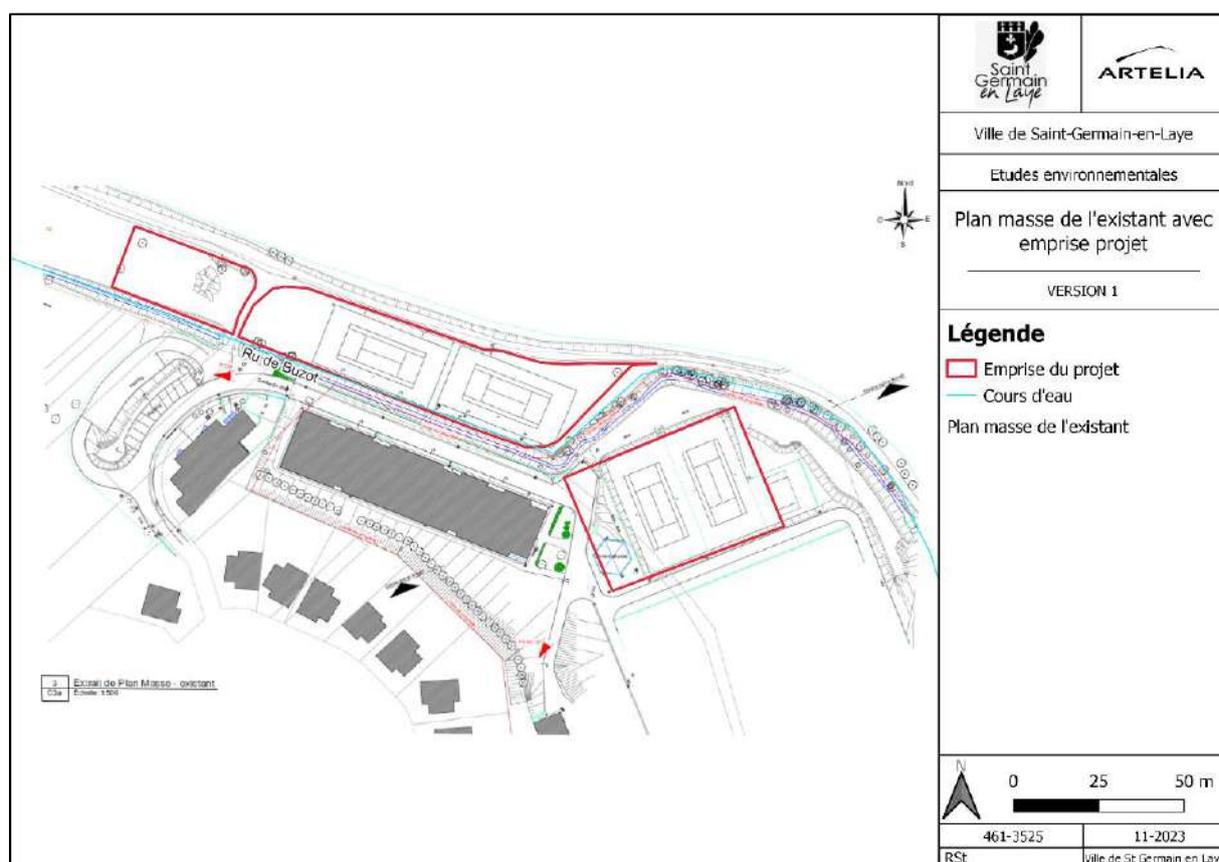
Plan masse de l'existant avec emprise projet, SAS Architecture 3J
